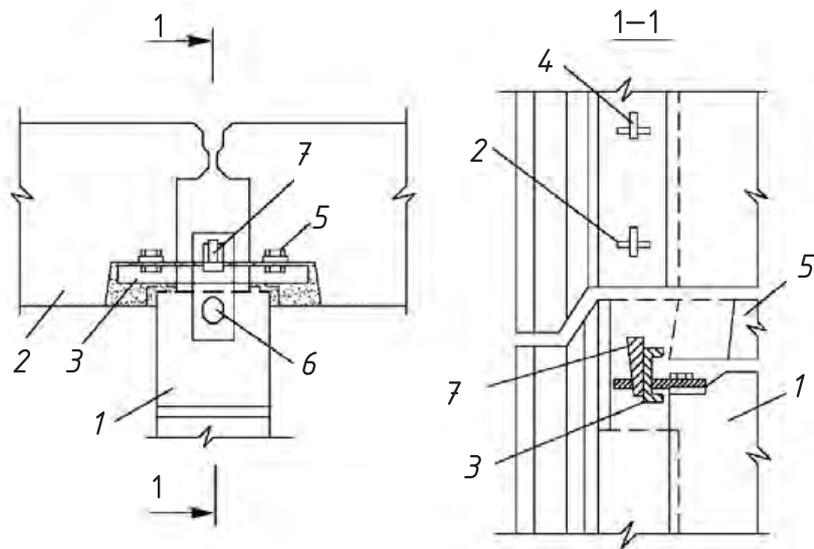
Конструкции связей болтовая: 1 — панель внутренней стены; 2 — петлевой арматурный выпуск; 3 — стыковая накладка; 4 — стальная скоба; 5 — панель перекрытия; 6 — болтовая связь; 7 — стальной клин
